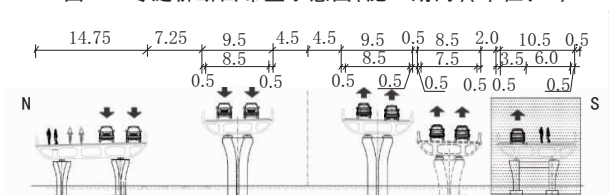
冬涟桥断面布置示意图(完成后)(单位:m)
